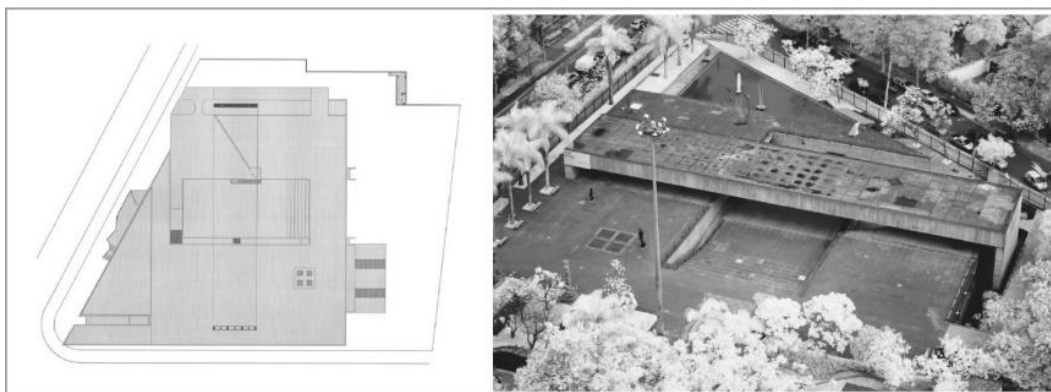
Mube. Planta baixa e vista aérea. Fonte: melissabermudez.files.wordpress.com (2016)
